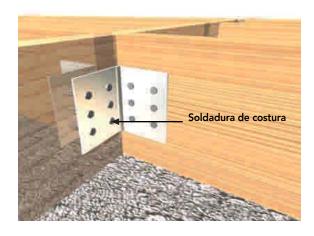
46: Conector fabricado con pletina de espesor 3 a 4 mm conformado por dos piezas que se unen mediante soldadura de costura, como se puede apreciar en la figura.
